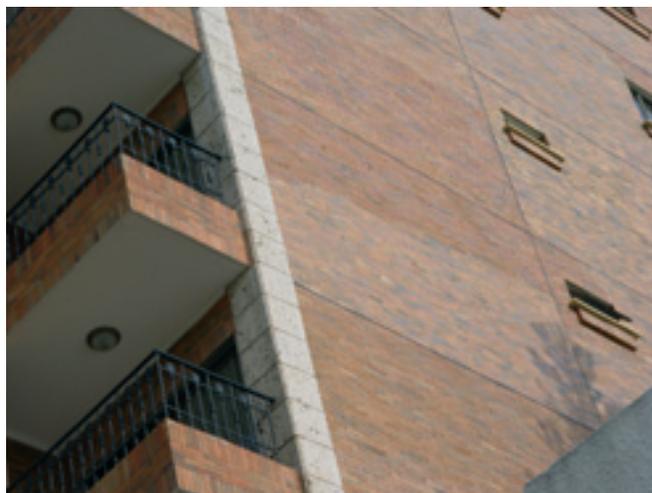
adecuada disposición y sello de juntas en fachada evitando esfuerzos entre elementos, por dilatación, que puedan desprenderlos.
